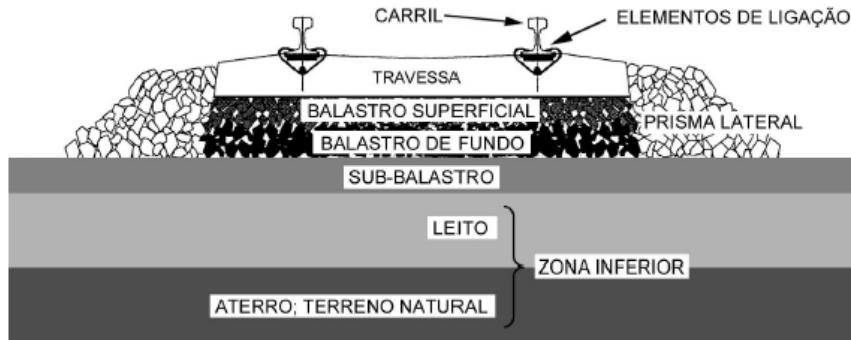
Perfil Transversal de Via Ferroviária Balastrada, adaptado (Fortunato, 2005)
